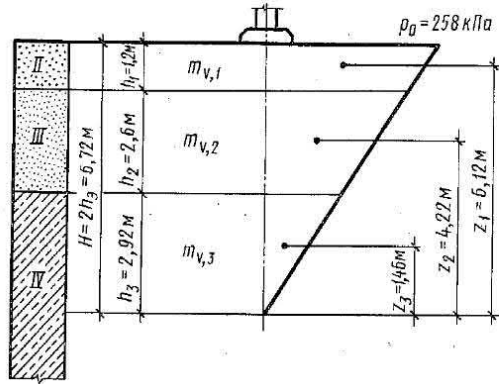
Схема к расчету осадки фундамента методом эквивалентного слоя (пример 10.3)
